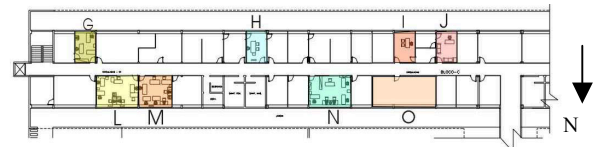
Planta baixa Bloco B, primeiro andar
